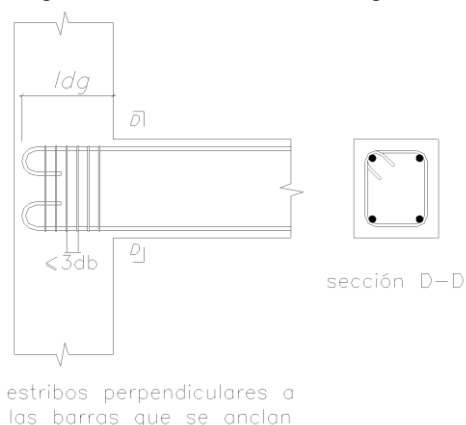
c Caso con gancho estándar a 180° con Ψ_r igual a 0,8
